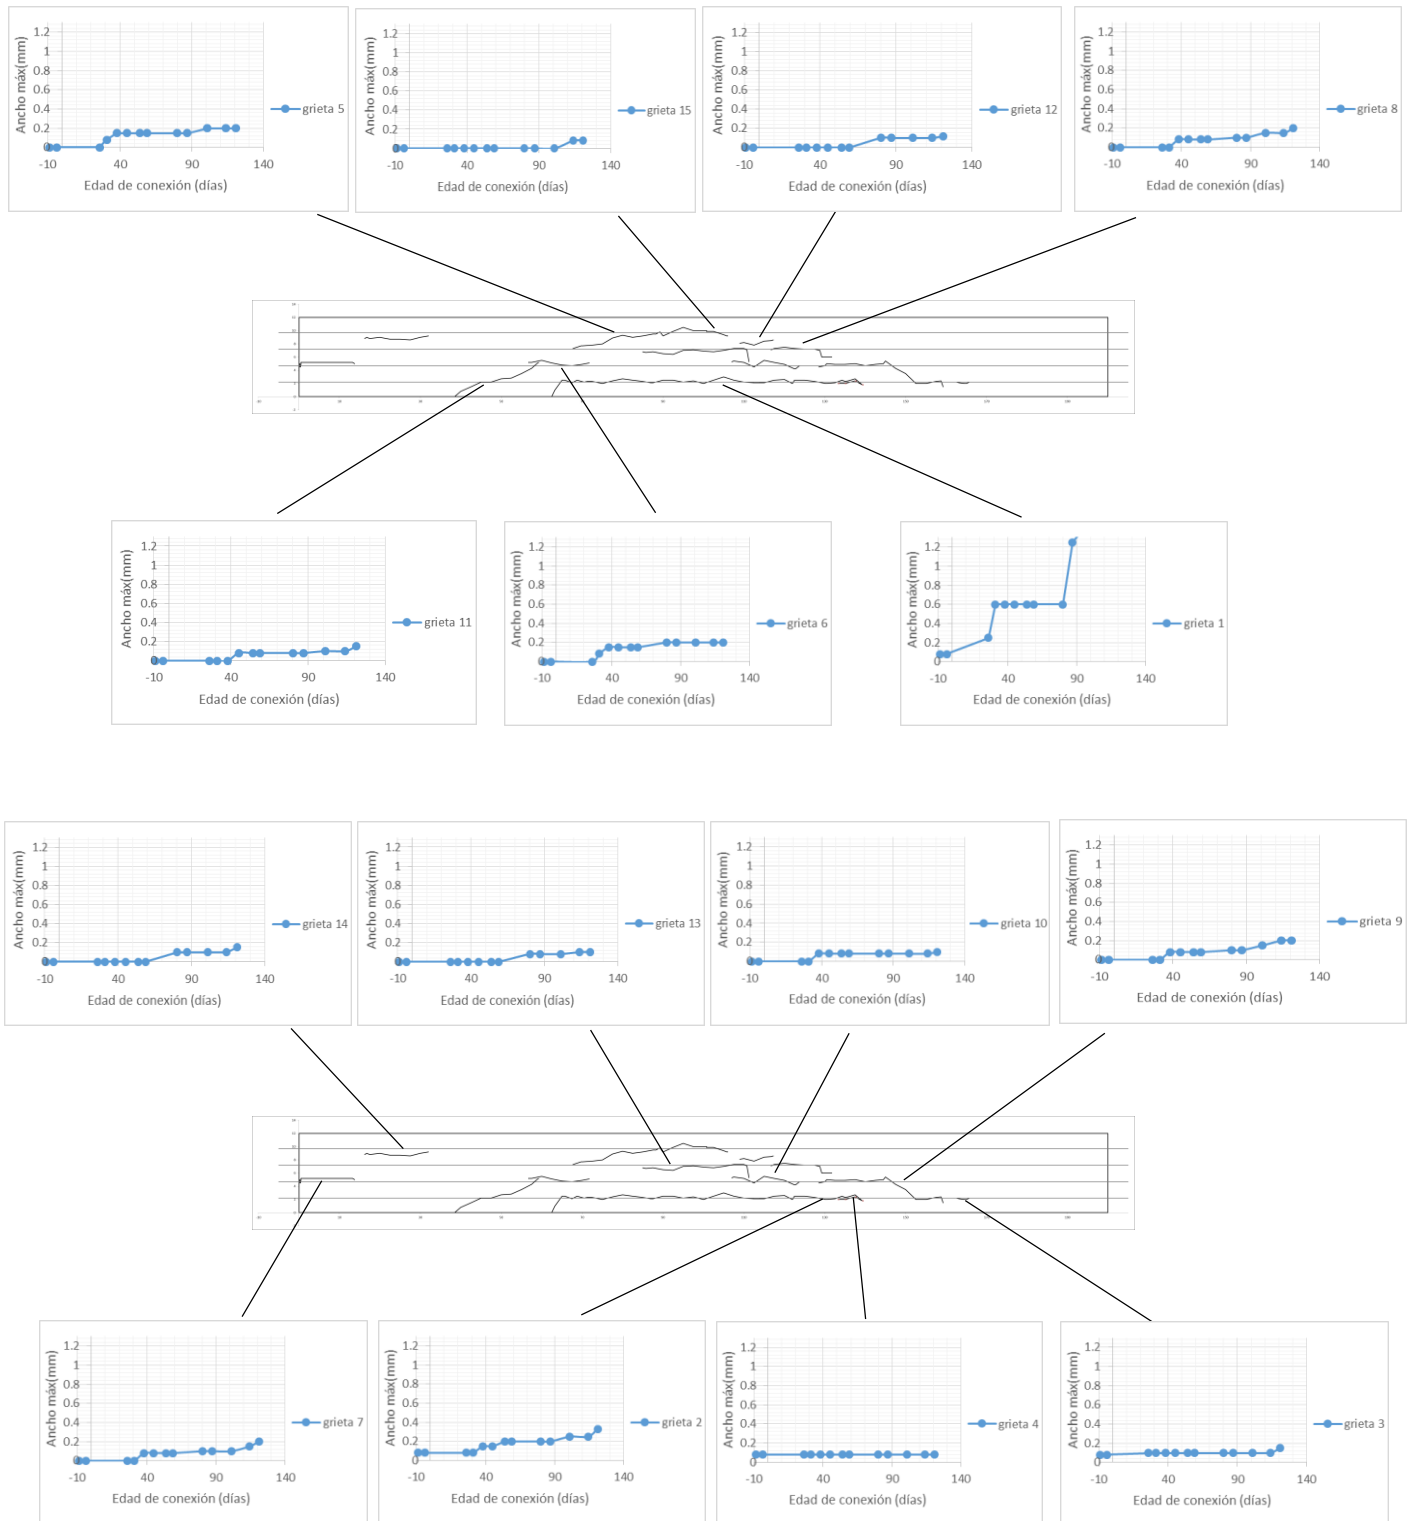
Localización y ancho máximo de grieta viga VCPC6.
